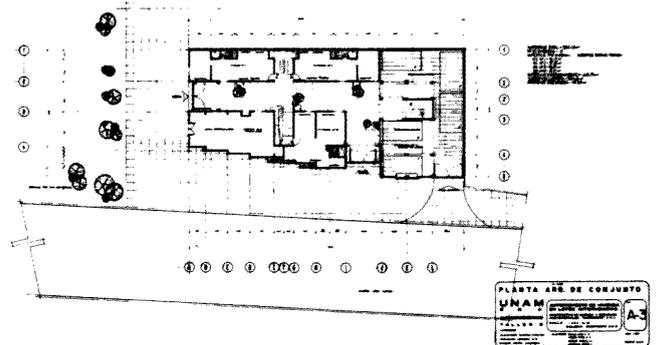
Conjunto habitacional en Luna 39, en un terreno que hace esquina con la Plaza de Los Angeles. Planta de conjunto. El proyecto intenta crear un patio central lineal, con criterio de calle. Trabajo realizado por estudiantes del Taller 5 del Autogobierno. 1977.
